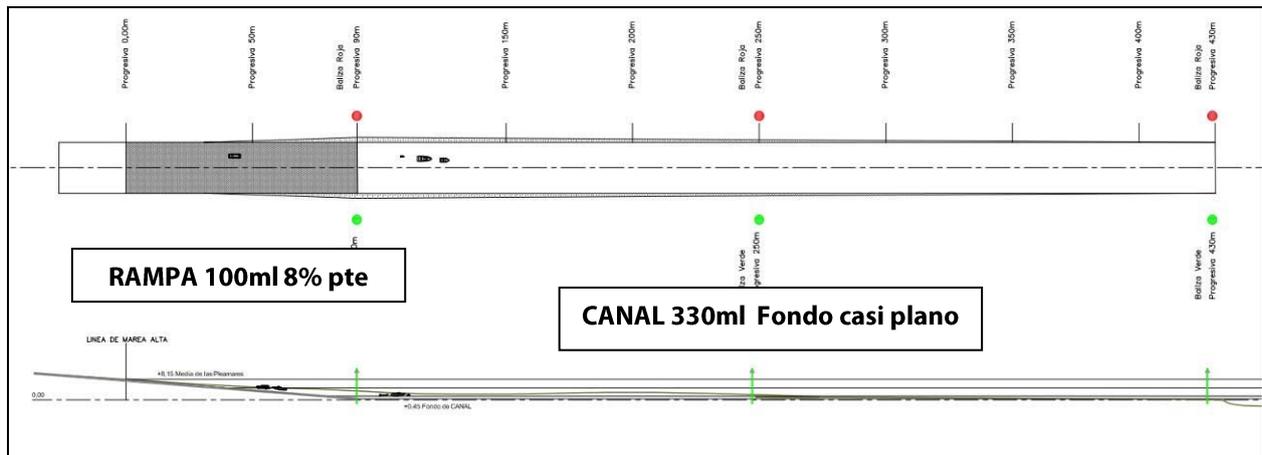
Extracto de Plano, vista en planta y corte longitudinal del canal de acceso. Fuente: elaboración propia
